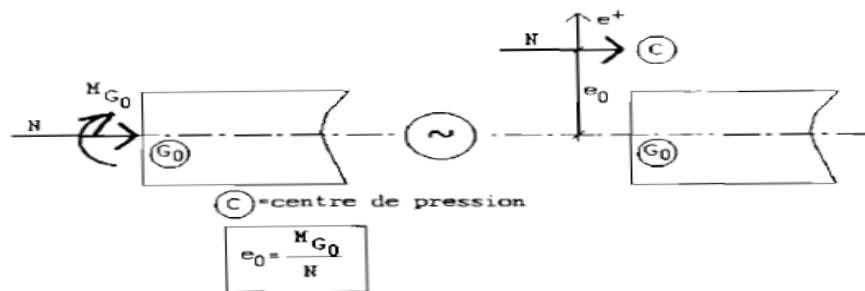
Excentricité par rapport au centre de gravité de la section de béton [1]
